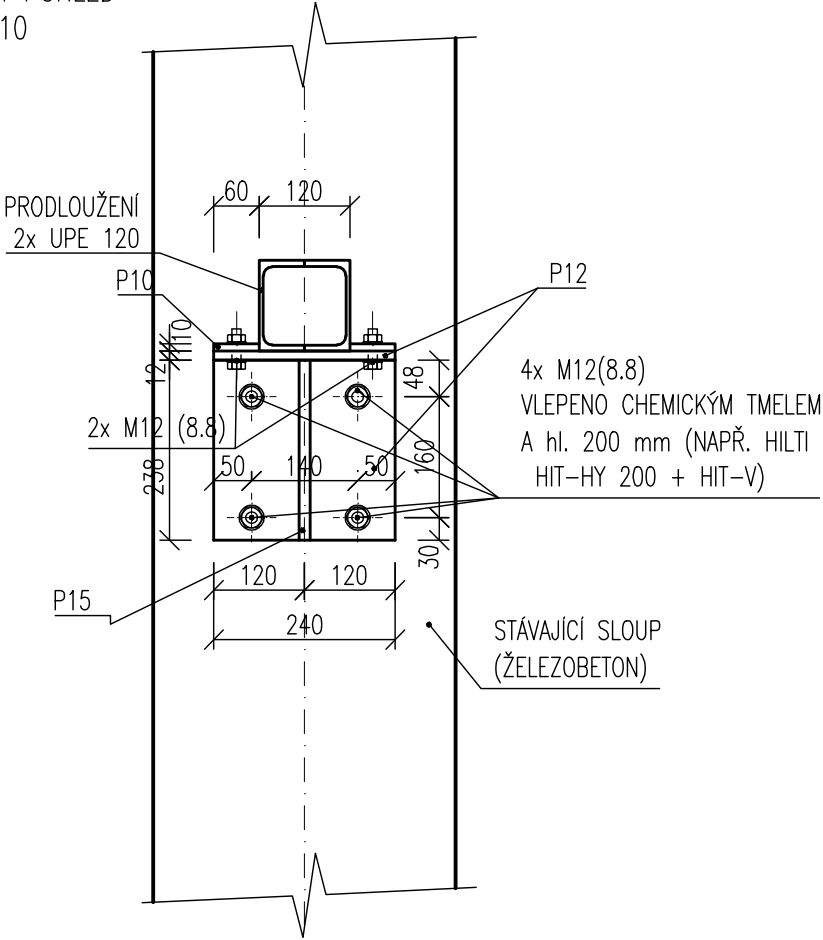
PŘIPOJENÍ NOSNÍKŮ K BETONOVÝM SLOUPŮM
